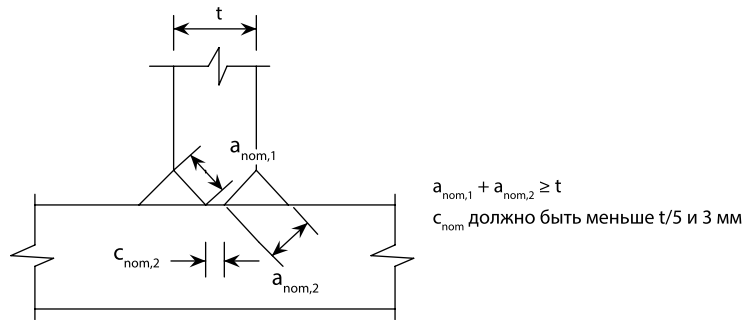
Эффективный стыковой шов в тавровом соединении с полным проваром, двусторонней разделкой кромок и усилением наложенными поверх угловыми сварными швами
